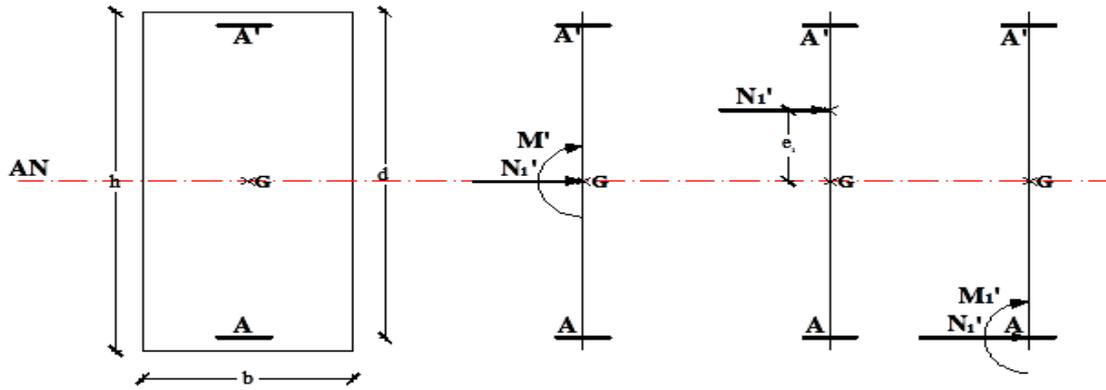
Position de N'_1 , M'_1 et M_1 sur la section transversale
